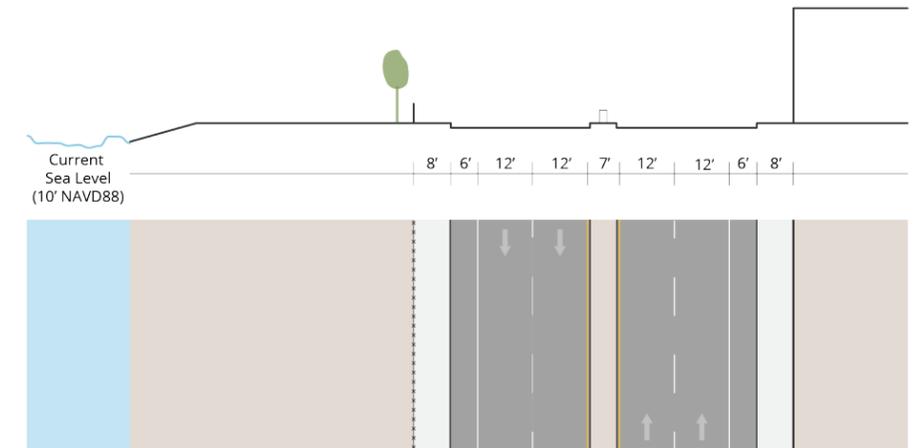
FIG XX - SECCIÓN EXISTENTE DEL CORREDOR DE LA RUTA 1A EN ADDISON STREET
